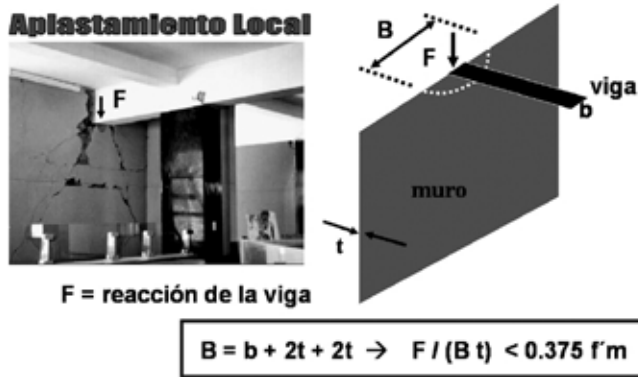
Caso de viga transversal que apoya en la albañilería.
